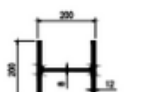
Detail *Baseplate* Gedung Damkar Proyek Rekonstruksi Pelabuhan Donggala
